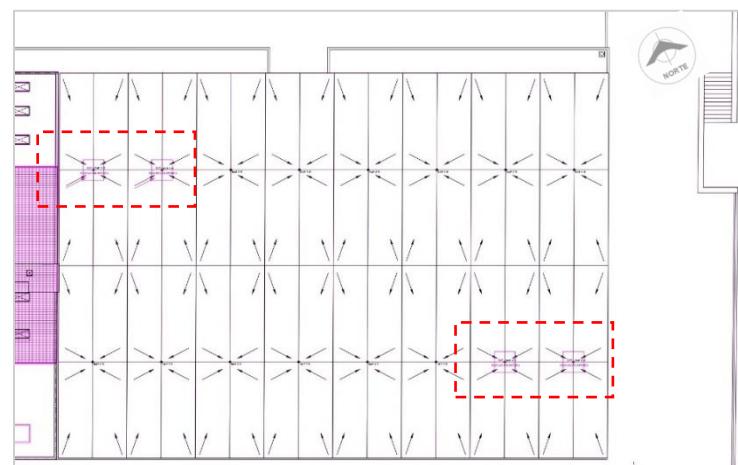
Planta de azotea-área de paraboloides (Elaboración propia).
